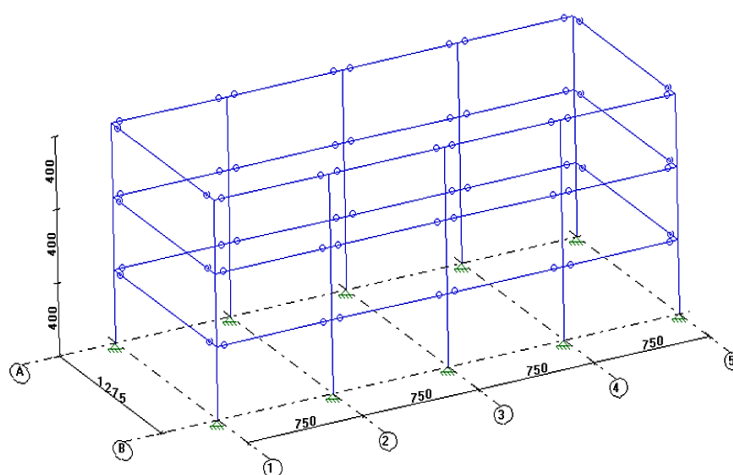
Esquema estrutural com 3 pavimentos representado por modelo de pórtico tridimensional
